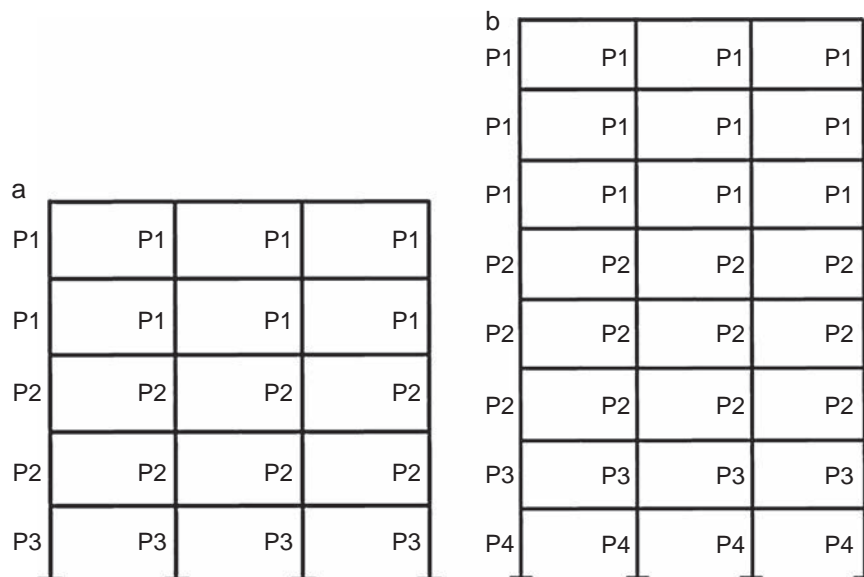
Alzado del pórtico interior de cada estructura. a) Edificio de cinco plantas. b) Edificio de 8 plantas.
